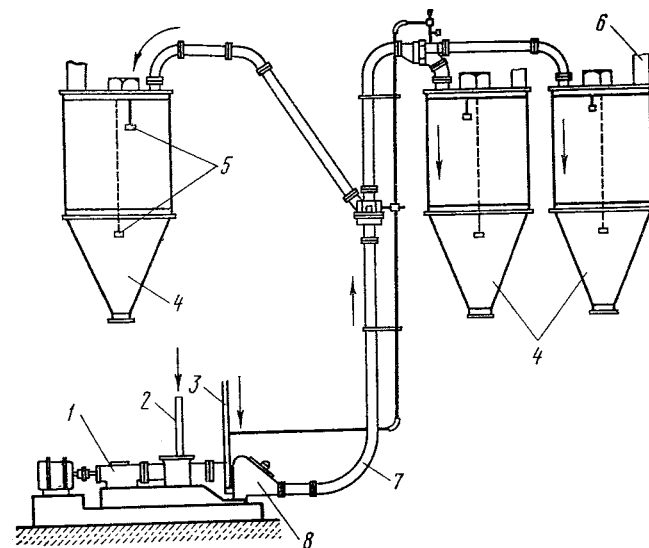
Схема нагнетательной установки для пневматического транспортирования цемента:
